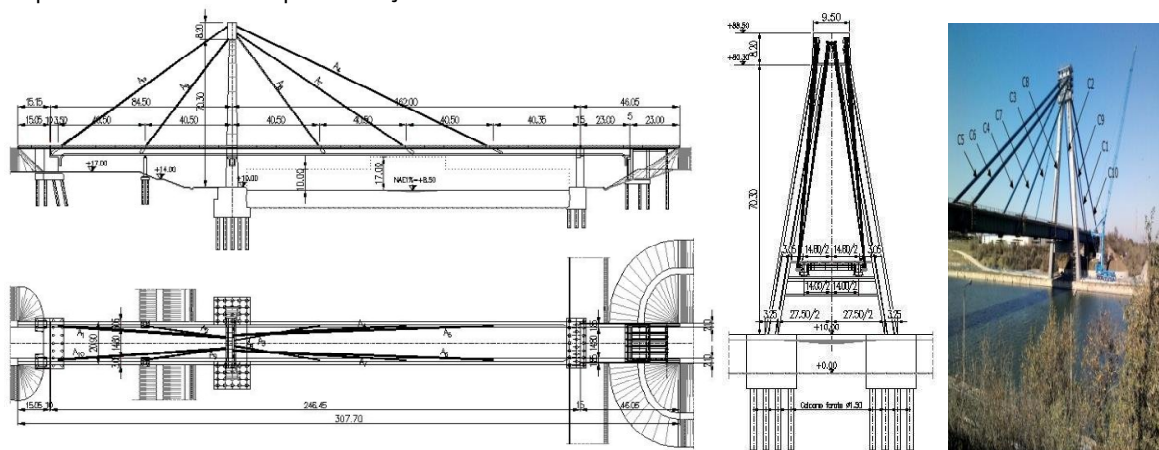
Elemente constructive ale Podului peste Canal Dunăre-Marea Neagră, loc. Agigea
